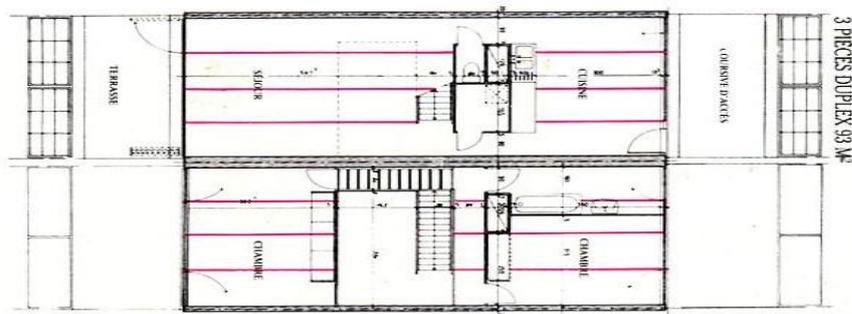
Plantas tipo de los departamentos Nemausus 1. Fuente: Urban Design. Newcastle University
